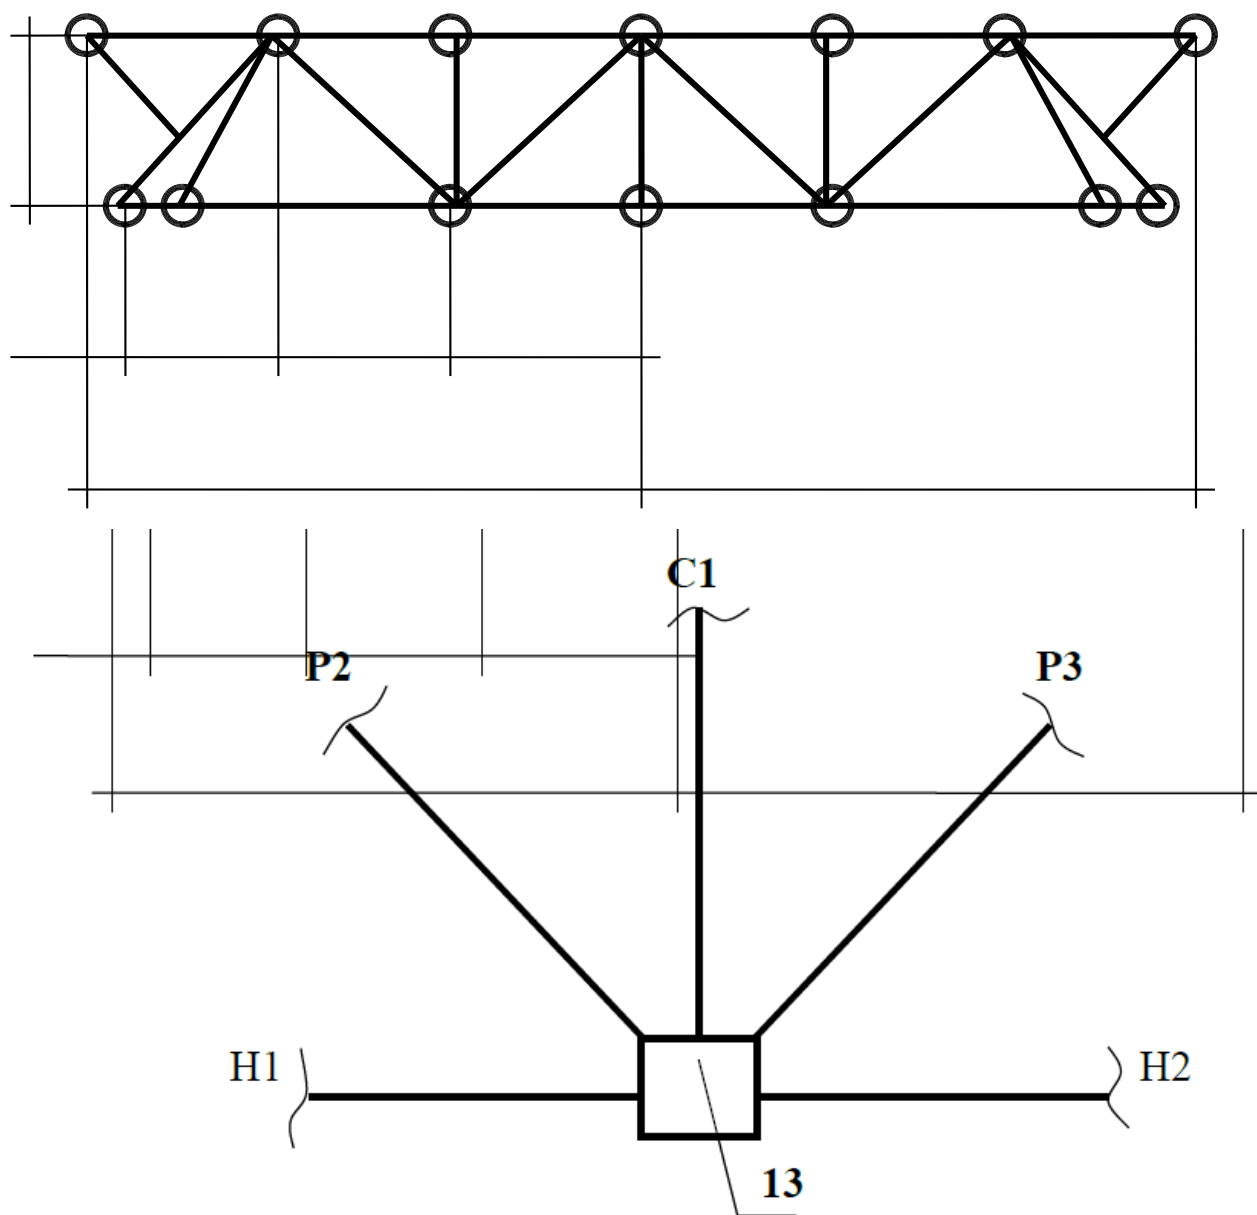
Геометрическая схема стальной фермы покрытия VI-ФС 18-4,40 и схема заданного узла фермы
